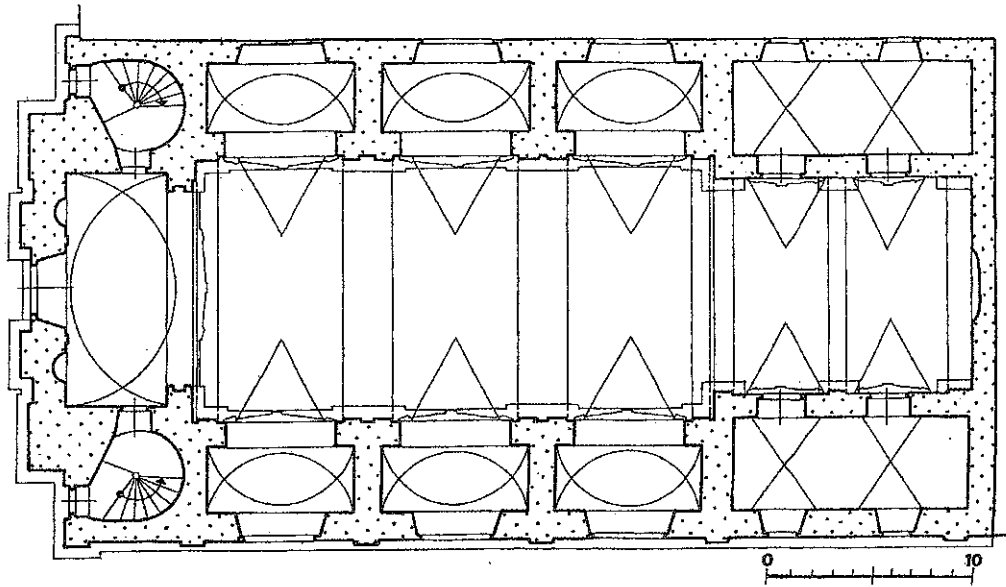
Jacopo Brascha, Jihlava/Iglau, Jesuitenkirche, 1680 – 1689, Grundriss.
